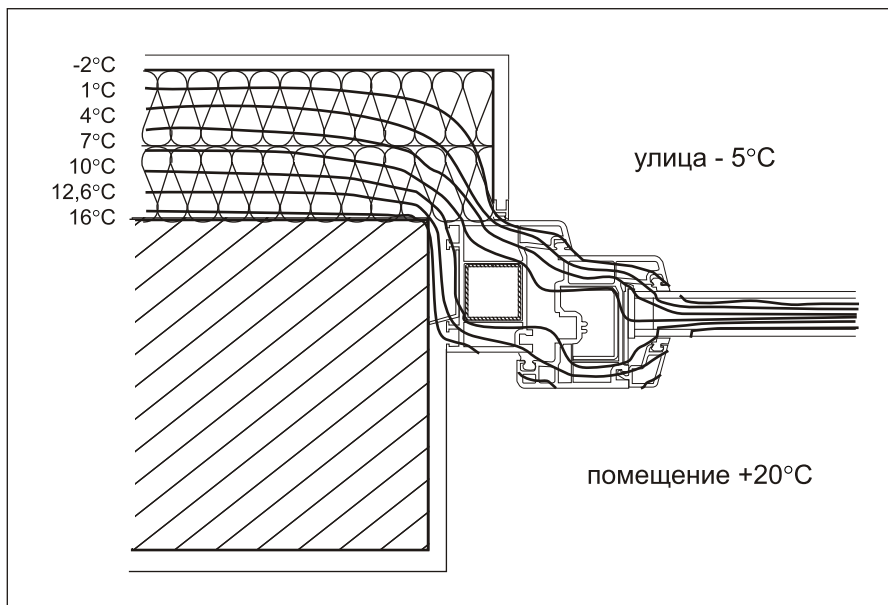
Бетонная стена с наружной изоляцией, пластиковое окно на уровне бетонной стены
